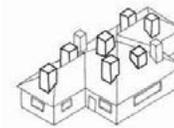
plano de múltiplas chaminés, publicado em *Sub-Plan*.
